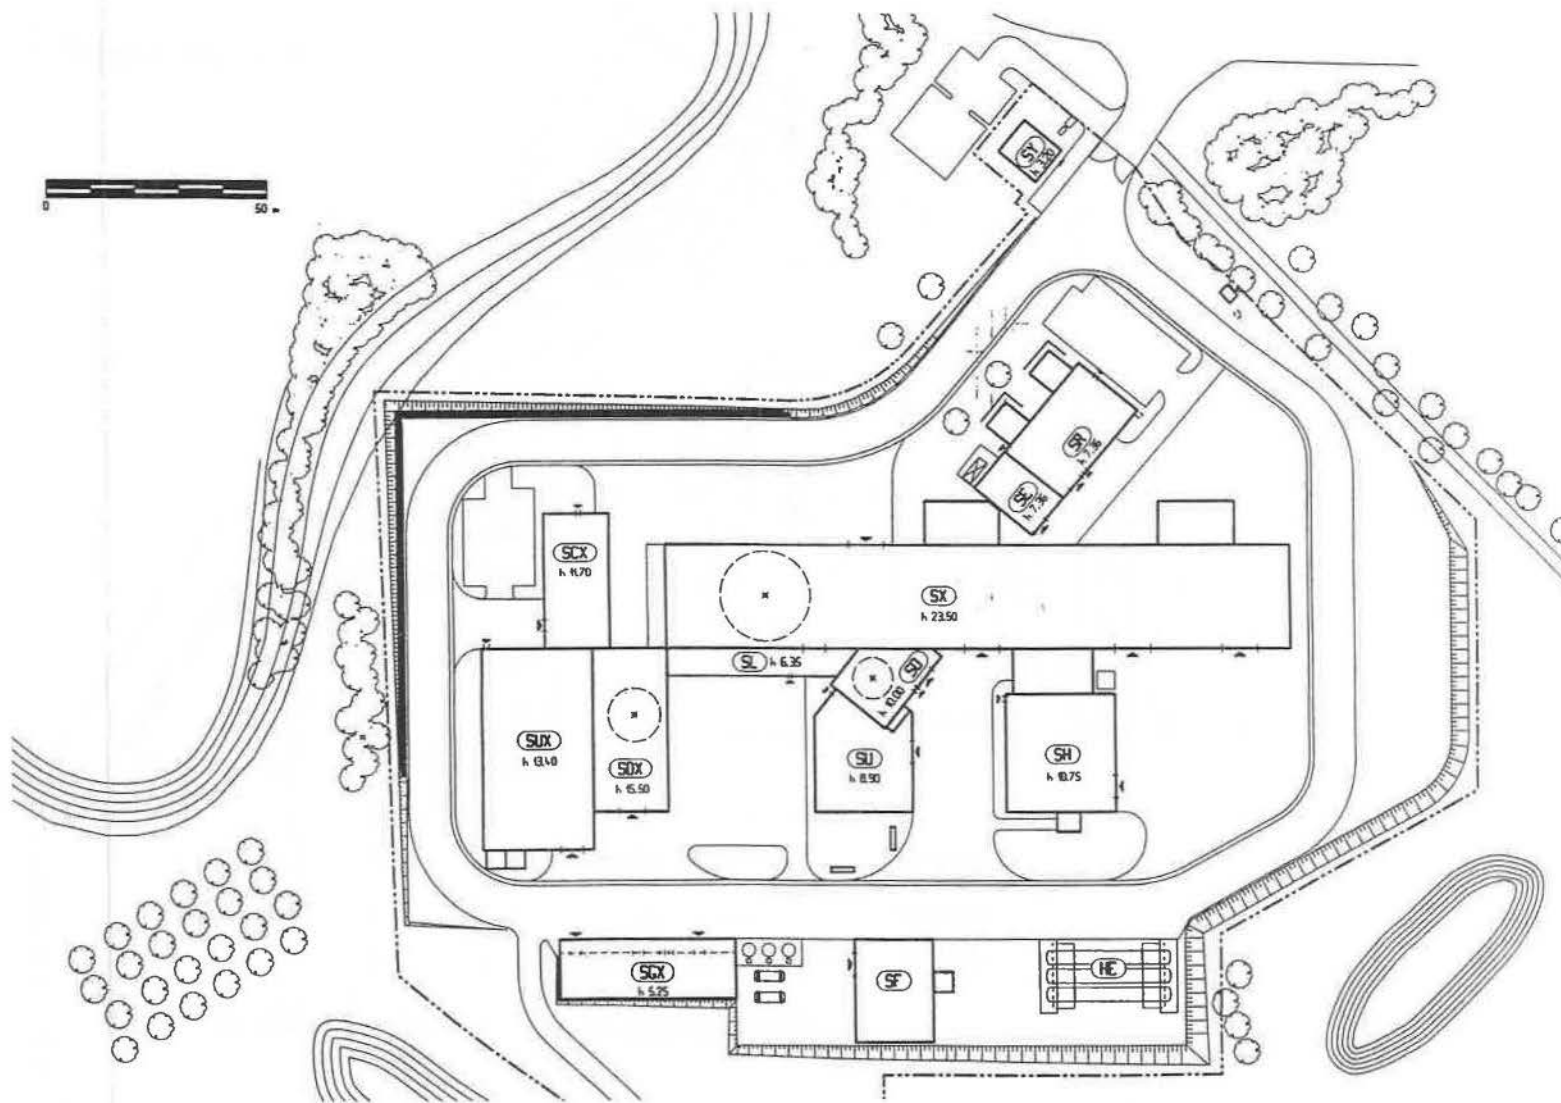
Point 5 : Plan de masse des bâtiments en surface du LHC
